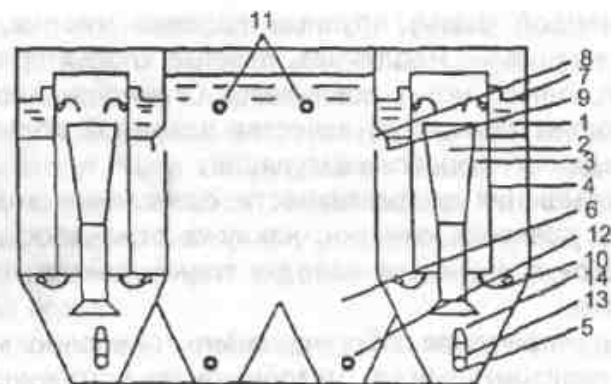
Осветлитель-рециркулятор: 1 — рабочая камера; 2 — смеситель; 3 — камера хлопьеобразования; 4 — направляющий аппарат; 5 — распределительная трубка; 6 — осадкоуплотнитель; 7 — лоток; 8 — окна; 9 — защитный козырек; 10 — слой взвешенного осадка; 11 — трубы для перепуска взвешенного осадка; 12 — трубы для выпуска уплотненного осадка; 13 — патрубок; 14 — сопло
